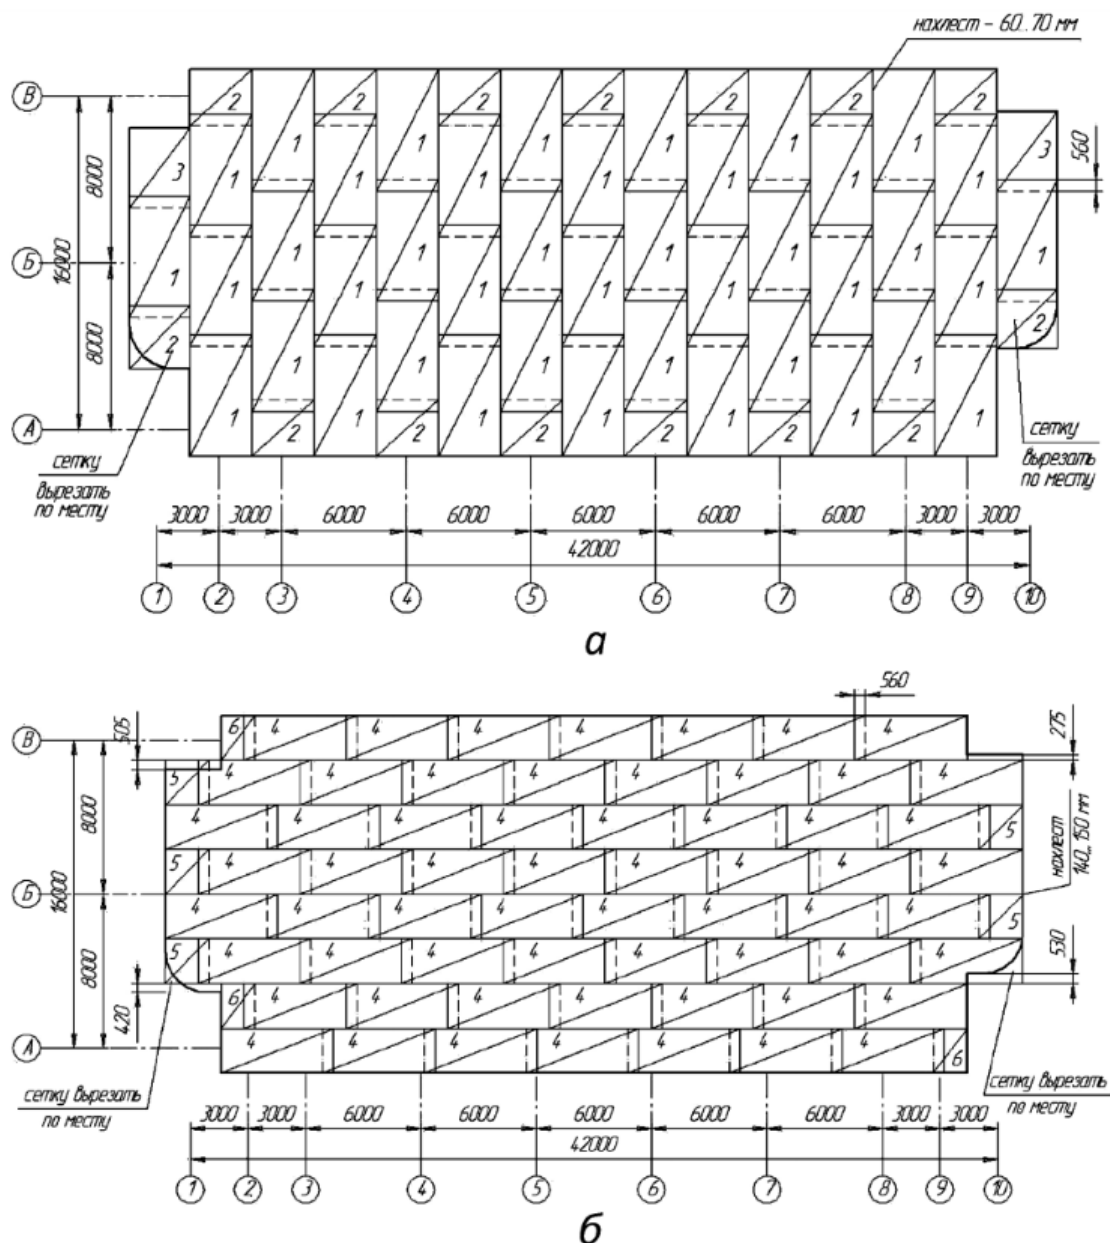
Схема армирования фундаментной плиты: *а* – раскладка сеток вдоль цифровых осей; *б* – раскладка сеток вдоль буквенных осей
